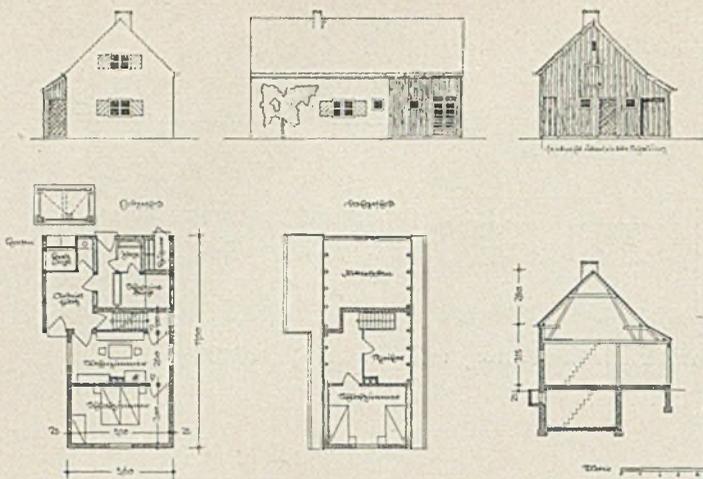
Kleinstsiedlung mit Kleintierstall nach dem Plan des Bayerischen Vereins für Heimatschutz i. M. 1:400
